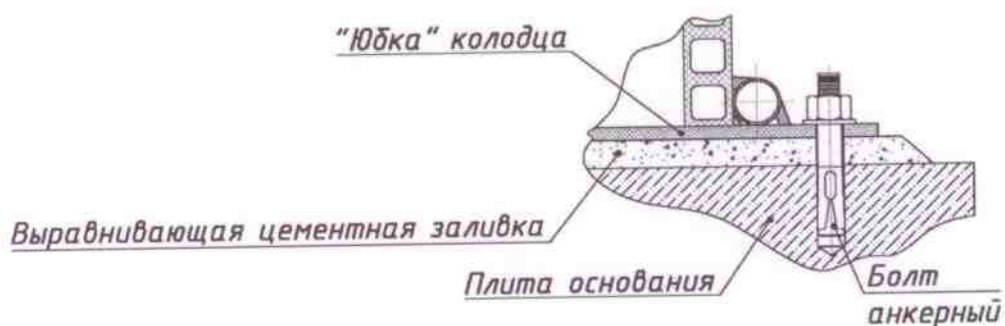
Схема крепления юбки колодца анкерными болтами к железно-бетонной плите
